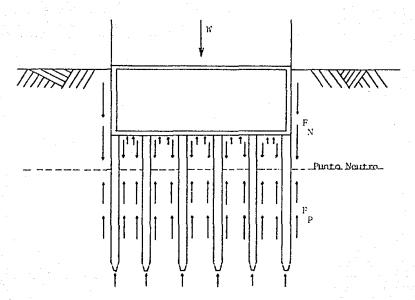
18. CAJON CON PILOTES DE FRICCION.
